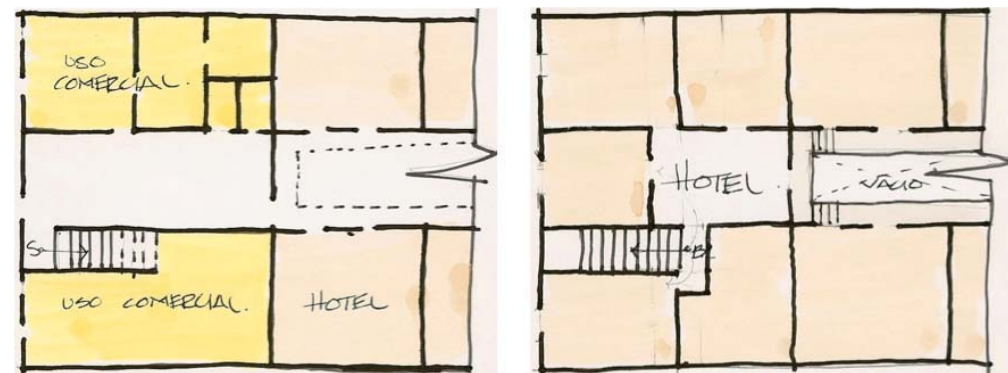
Plantas del "Hotel Palacio de Cristal". En estas se puede observar la configuración del inmueble y como se mezclan ambos usos. La parte comercial el frente del terreno en la planta baja y el hospedaje confinado al fondo del terreno en planta baja y en planta alta. Es importante señalar que esta configuración la adoptaron otros inmuebles que se encuentran en la misma categoría.
